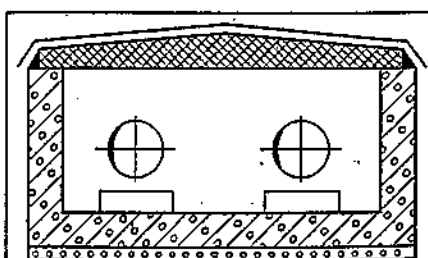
Canal necirculabil din beton armat monolit, acoperit cu plăci prefabricate.
